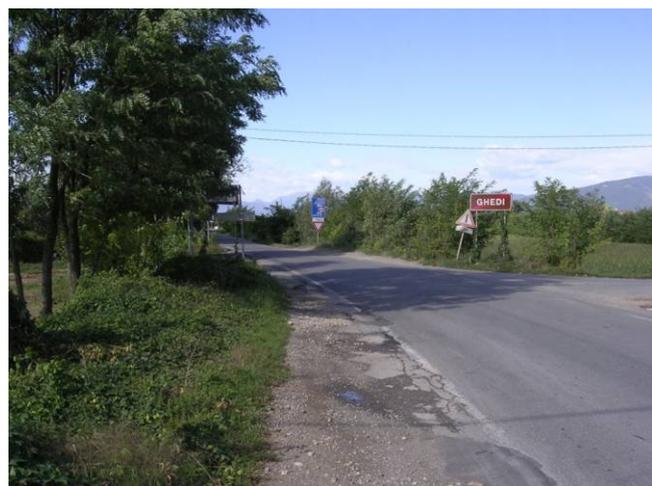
Foto 1: imbocco dalla via Santissima
